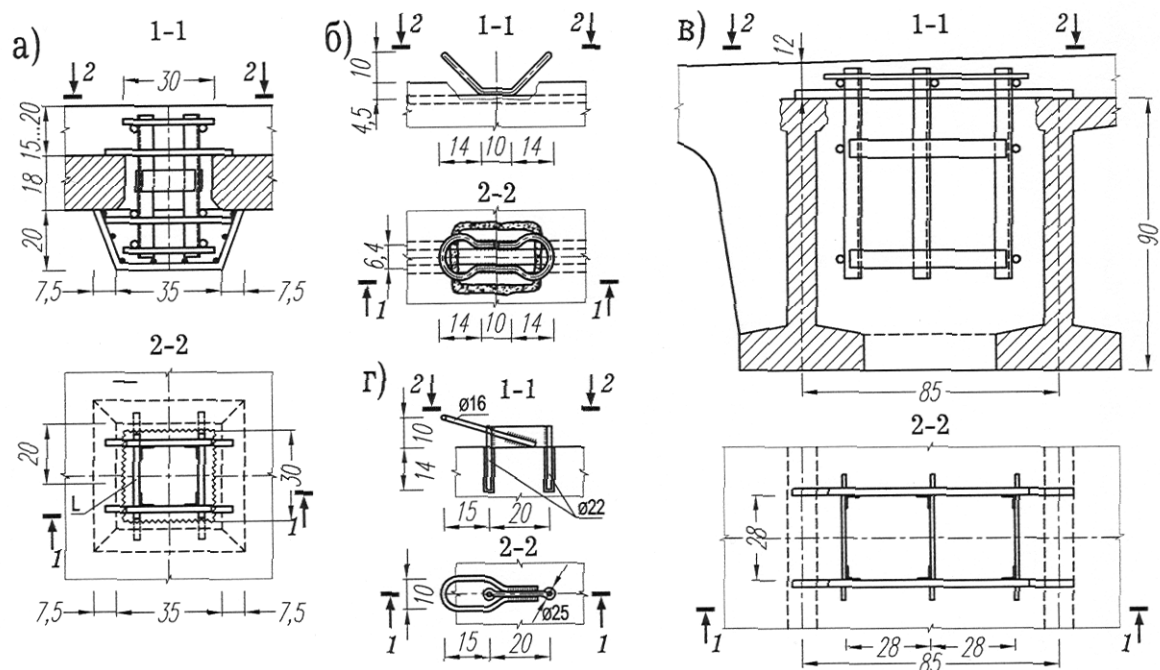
Деталі об'єднання монолітної залізобетонної накладної плити з існуючими балками:
